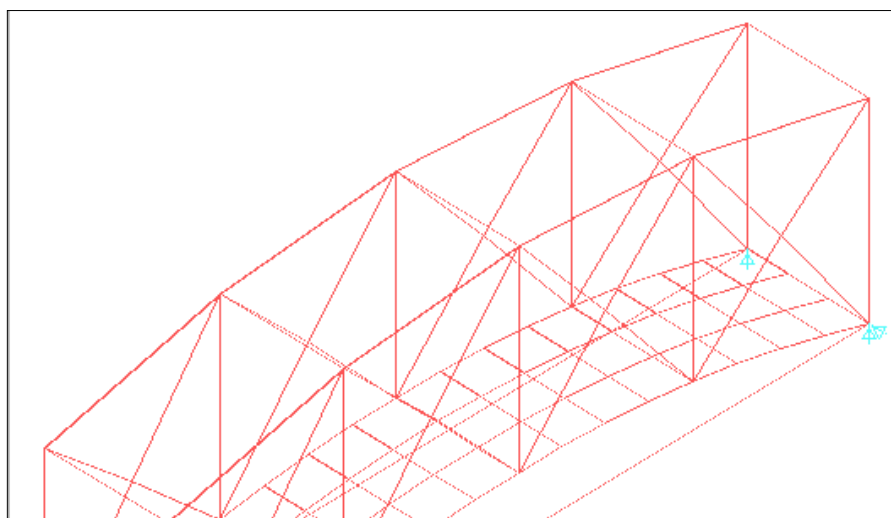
Restricciones y apoyos en el puente de 10m.
